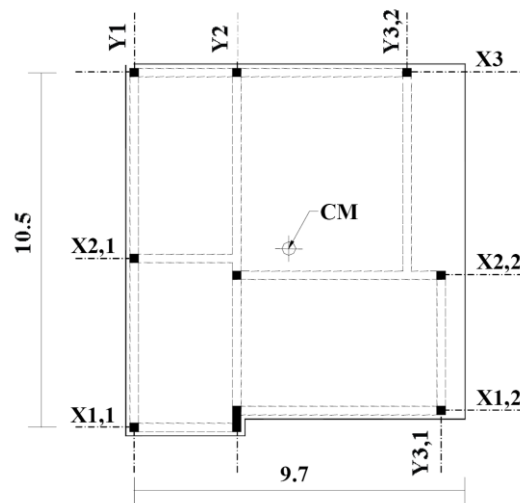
Pianta di un edificio multipiano in c.a.
